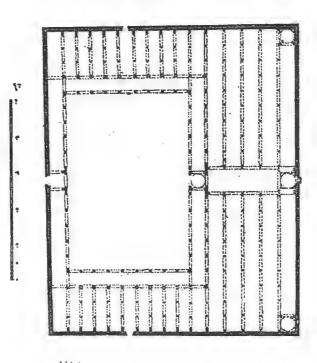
المسقط الأفقي لجامع أحمد بن طواون رالقاهر ق
